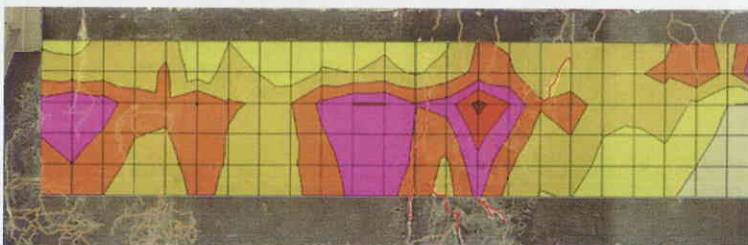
重ね合せ図 (原画像+ひび割れ+配筋図)
